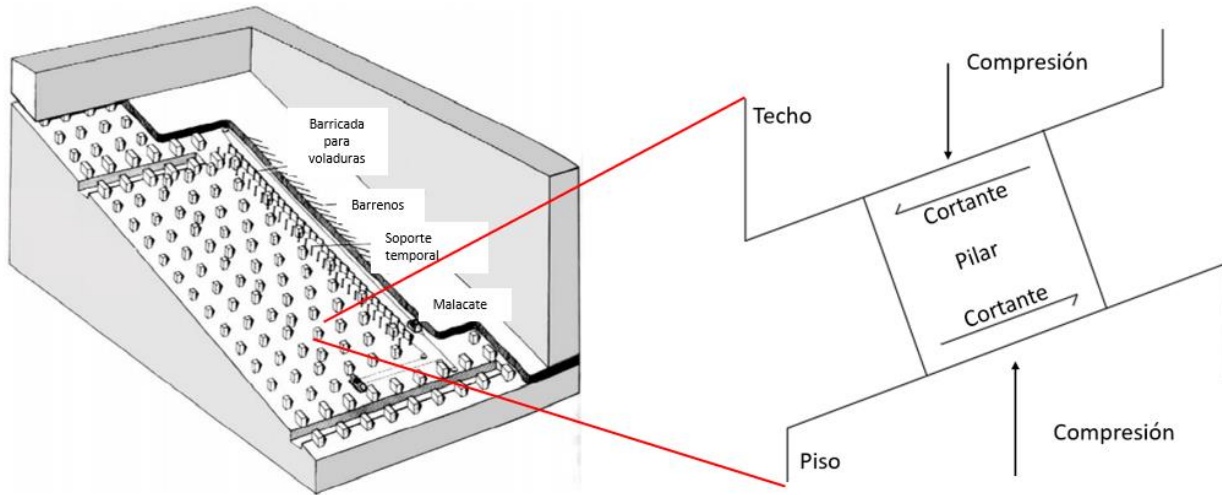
Minado de frentes largas en roca dura (Brady & Brown, 2005) y pilar inclinado dentro del manto (Modificado de Jessu & Spearing, 2018).
